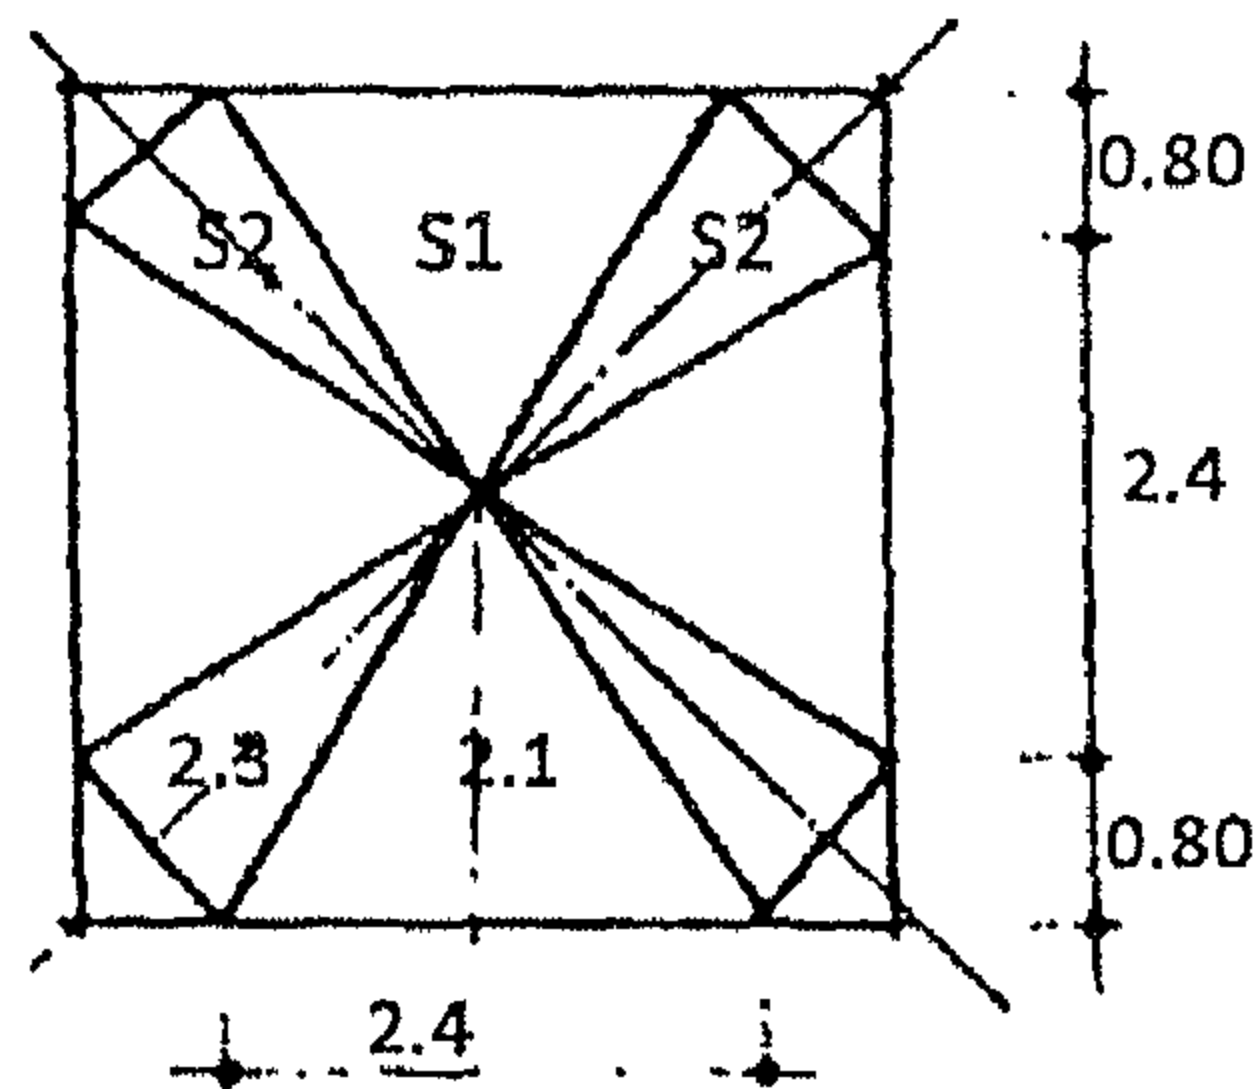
مسقط أفقي لبيان تفاصيل التسليح لسطح هرمي
